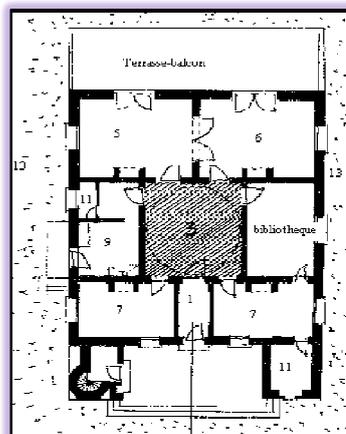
Plan Rez-de-chaussée d'une villa coloniale à Tunis
